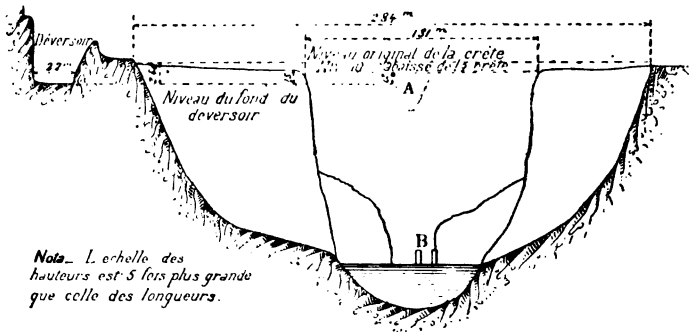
et 99. — Croquis du barrage de South Fork après sa rupture.
